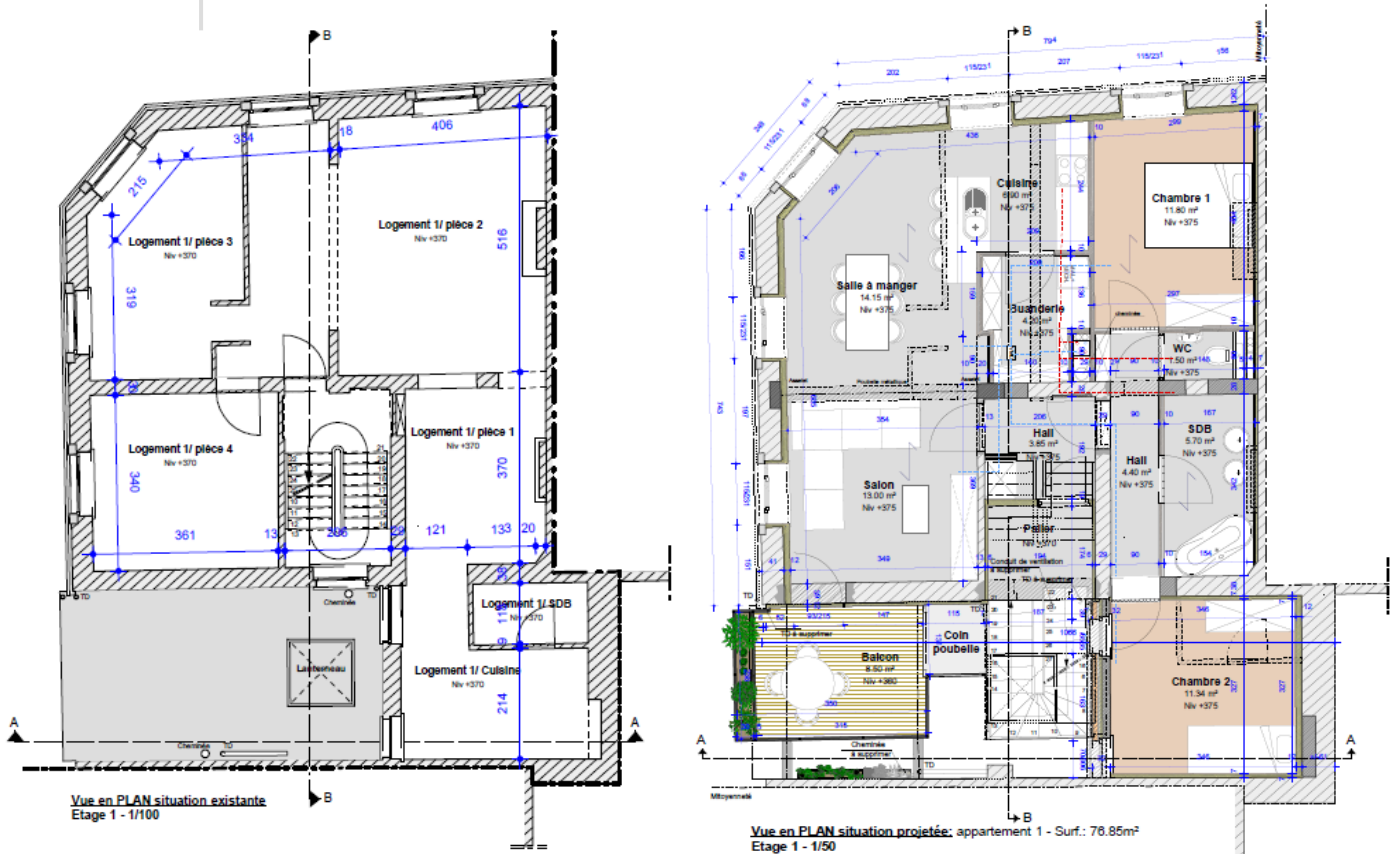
Vue en plan des situations initiale (à gauche) et projetée (à droite) de l'appartement (R+1) du chantier « Ferrer 13 ».
